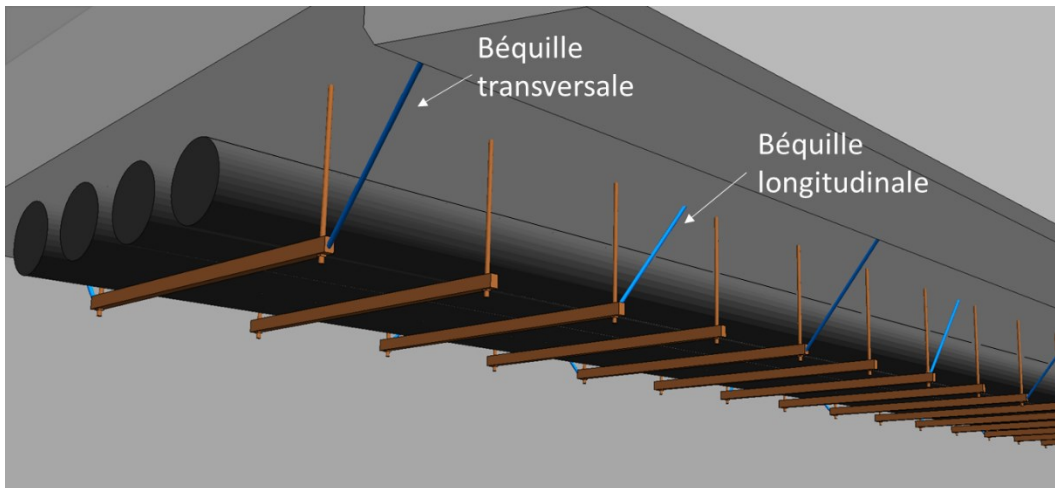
Rigidification des conduites dans le sens longitudinal et transversal
